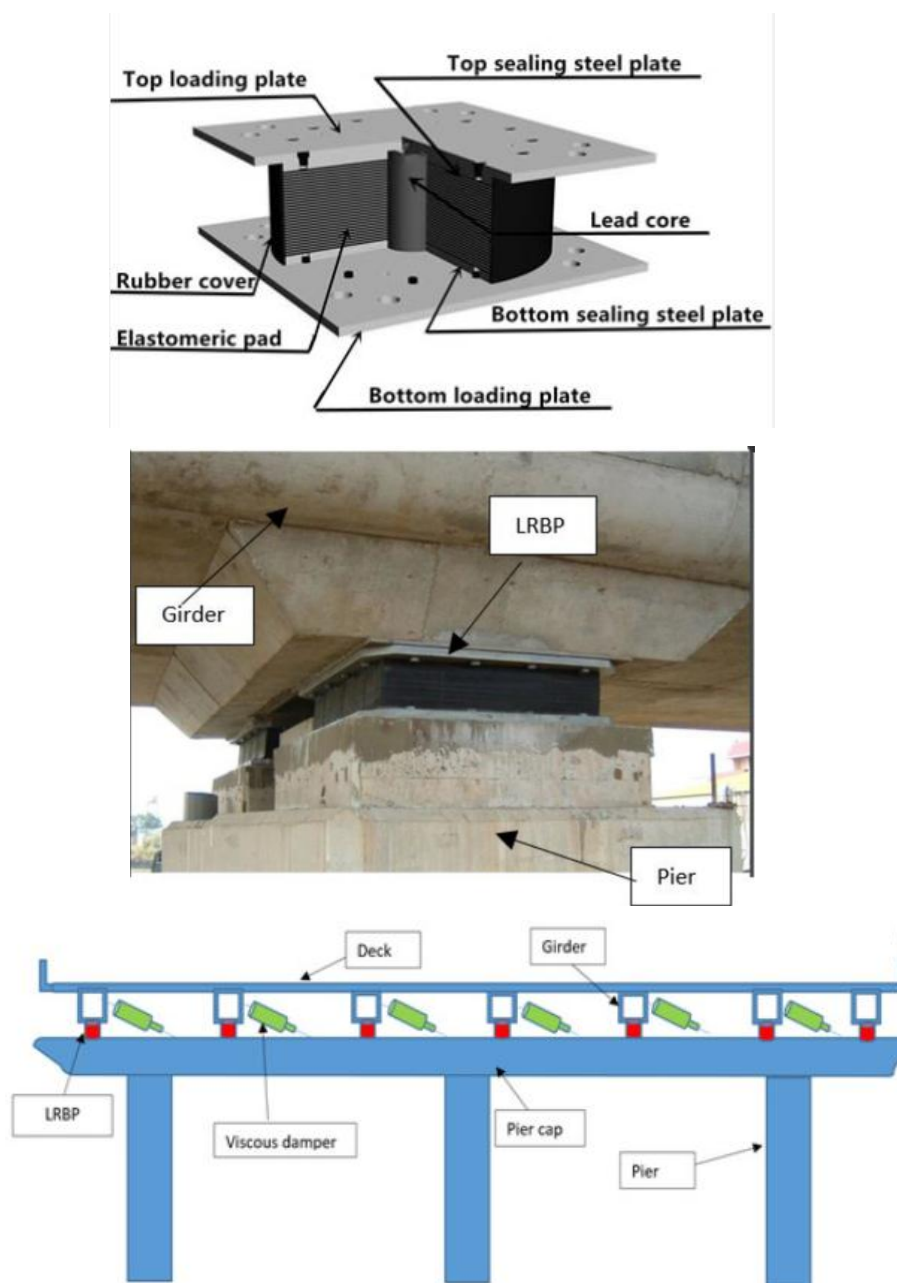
Сейсмічний ізолятора типу Lead Rubber Bearing
